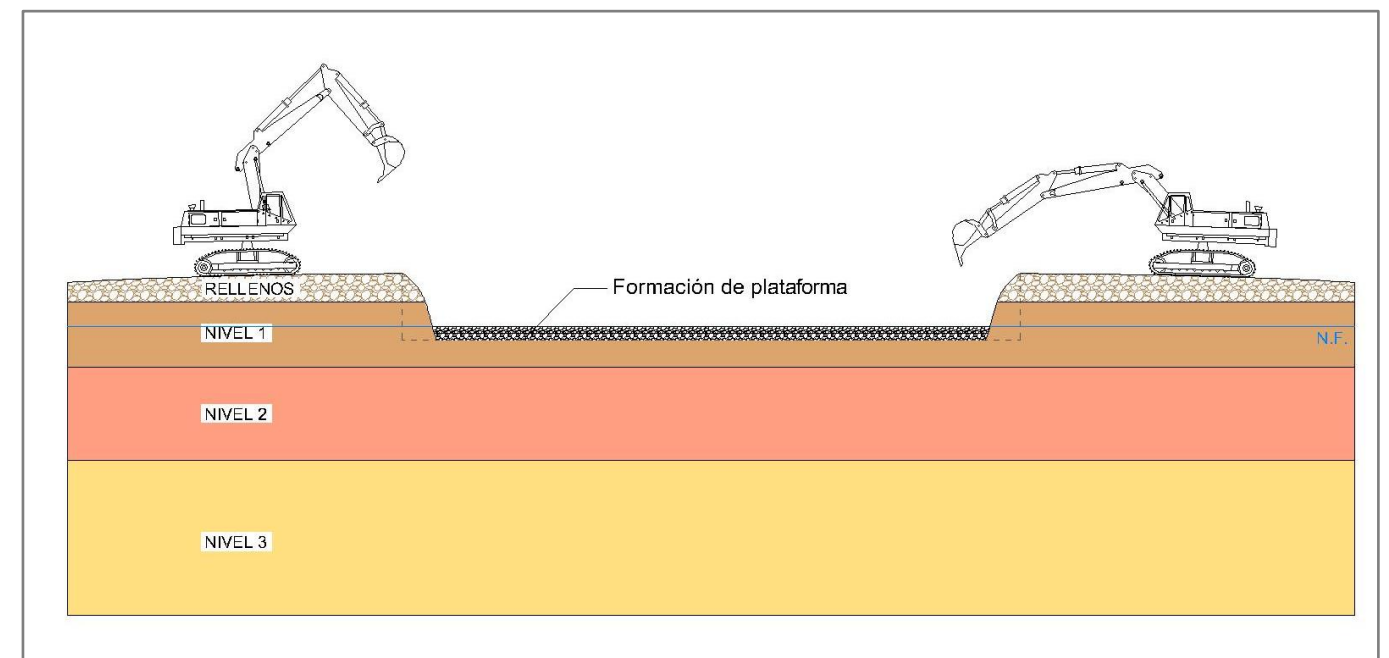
Primera fase de excavación: perfilado del terreno y formación de plataforma de trabajo.
